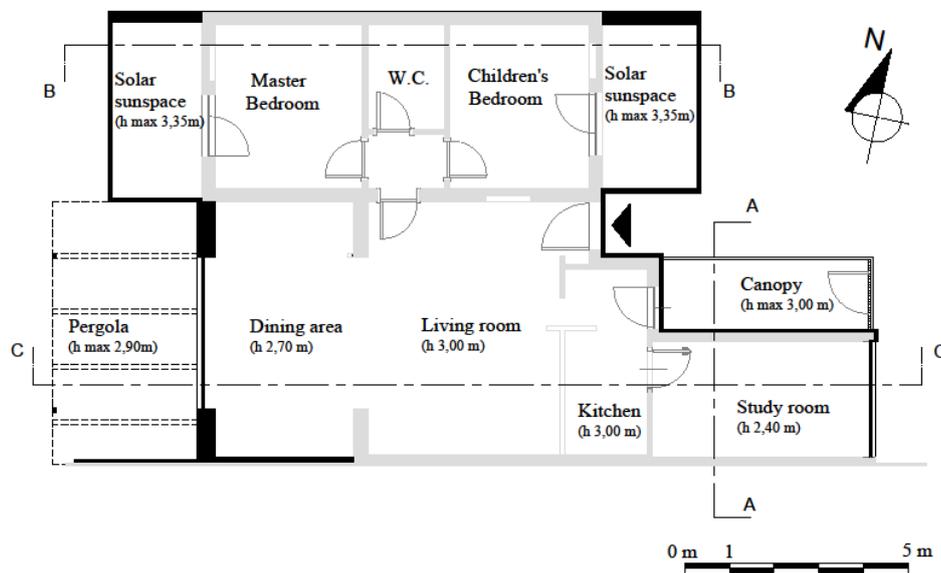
Pianta piano terra. Le linee nere evidenziano le parti oggetto di riqualificazione energetica
